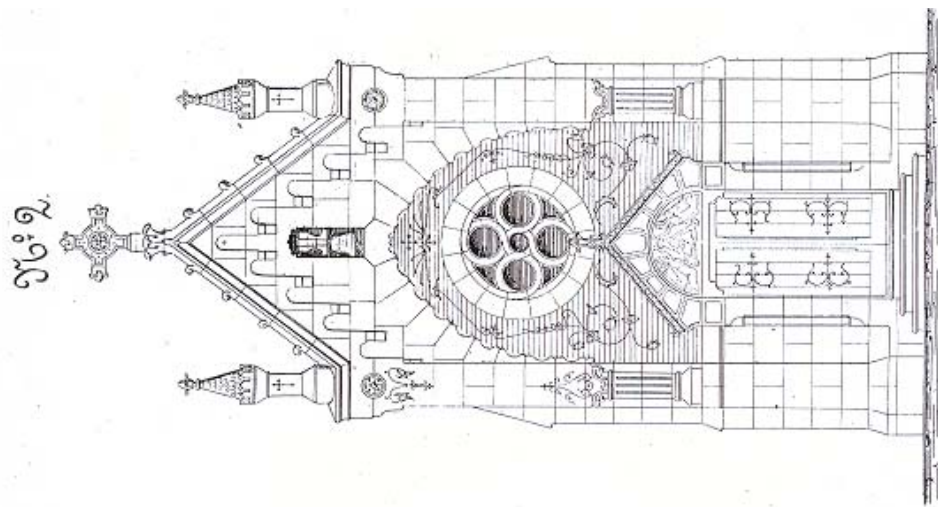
Planta y fachada de la capilla. José Marín Baldo
